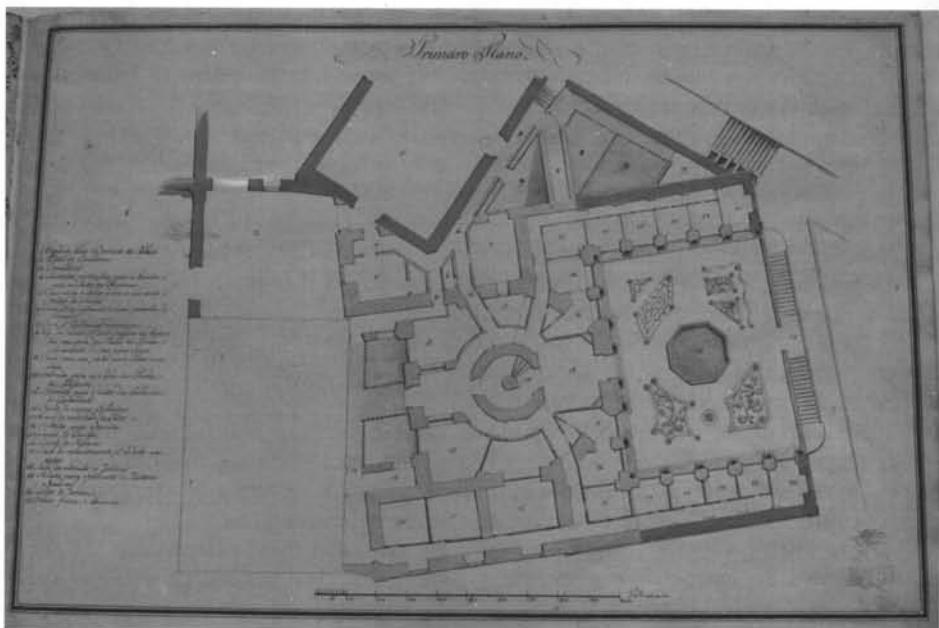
1.º Projecto: "2. Primeiro Plano".
